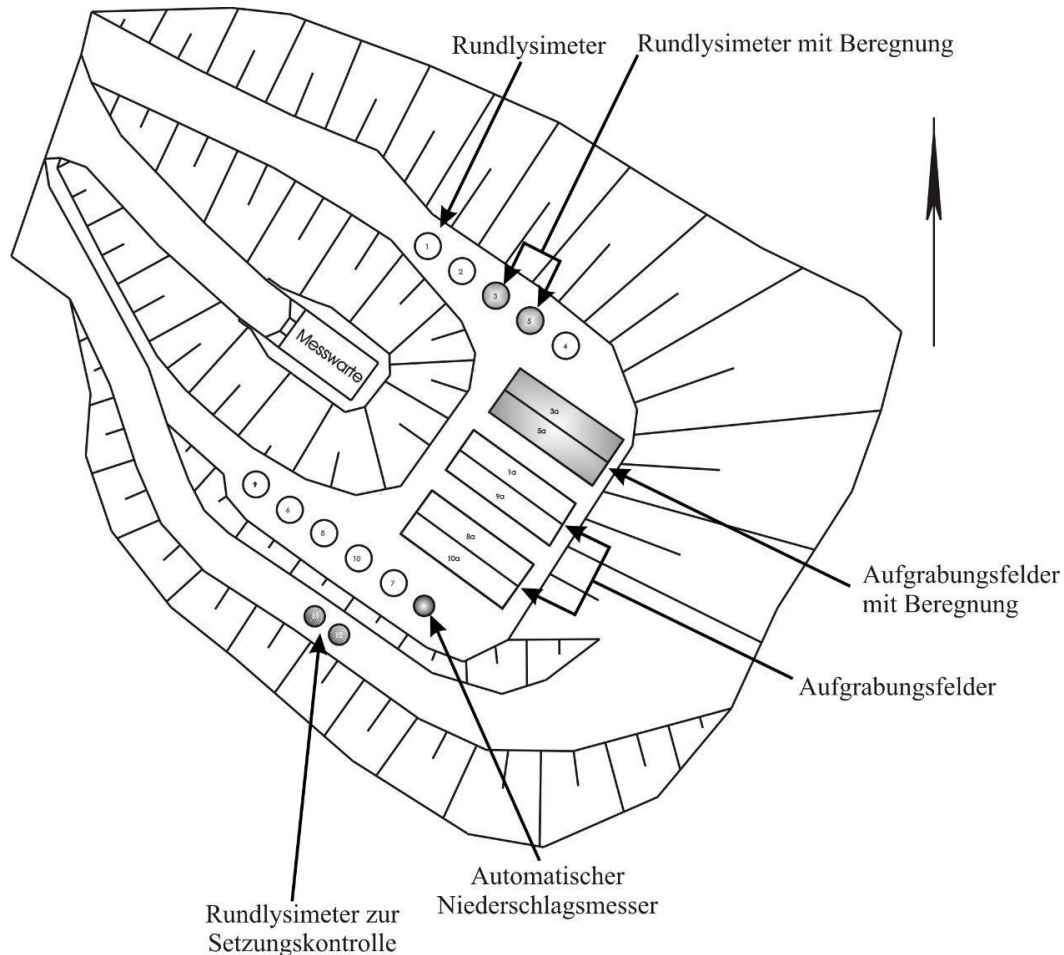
Grundriss der Lysimeteranlage Bautzen/Nadelwitz (nicht maßstabsgerecht)
